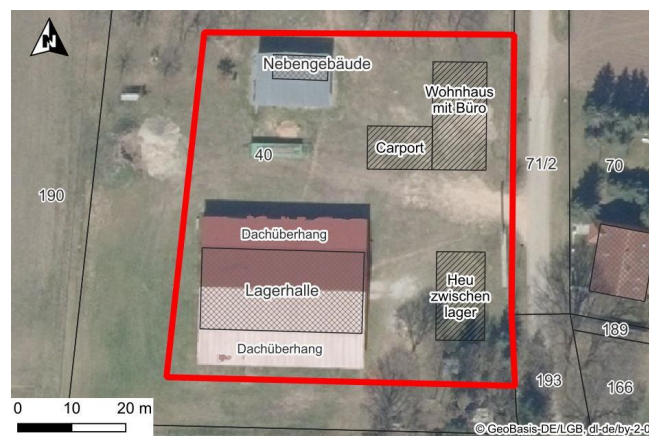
Aufteilung der geplanten Bebauung (schwarz dargestellt) und der bereits vorhandenen Bebauung (farbig) auf dem privaten Baugrundstück
